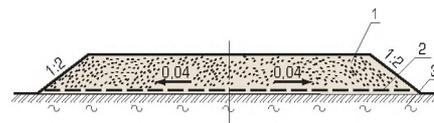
Конструкция насыпи на участках переувлажненных грунтов: 1 — песчаный грунт; 2 — прослойка из НСМ; 3 — переувлажненный грунт
